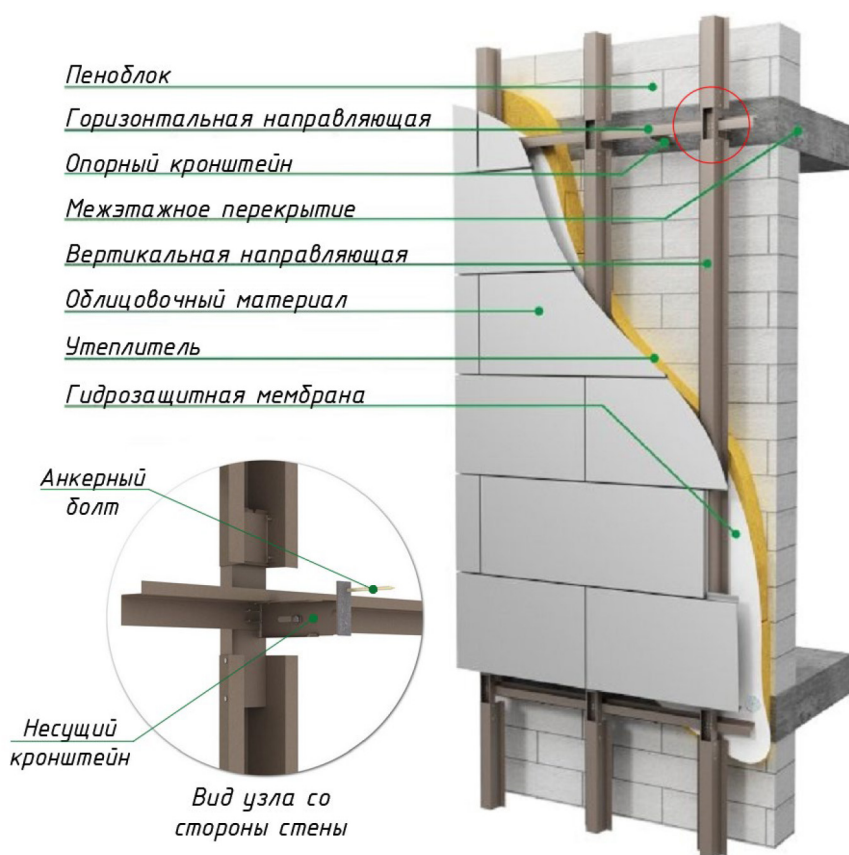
Принципиальное устройство конструктивной системы навесного вентилируемого фасада с креплением подсистемы в торцах плит перекрытий
